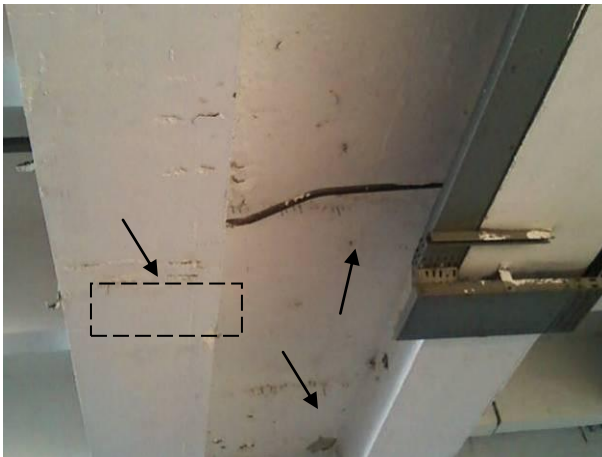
Fissuras transversais com eflorescências na face inferior da Viga calha do eixo 3, entre eixos B/C, observa-se também pontos localizados com armaduras expostas.
